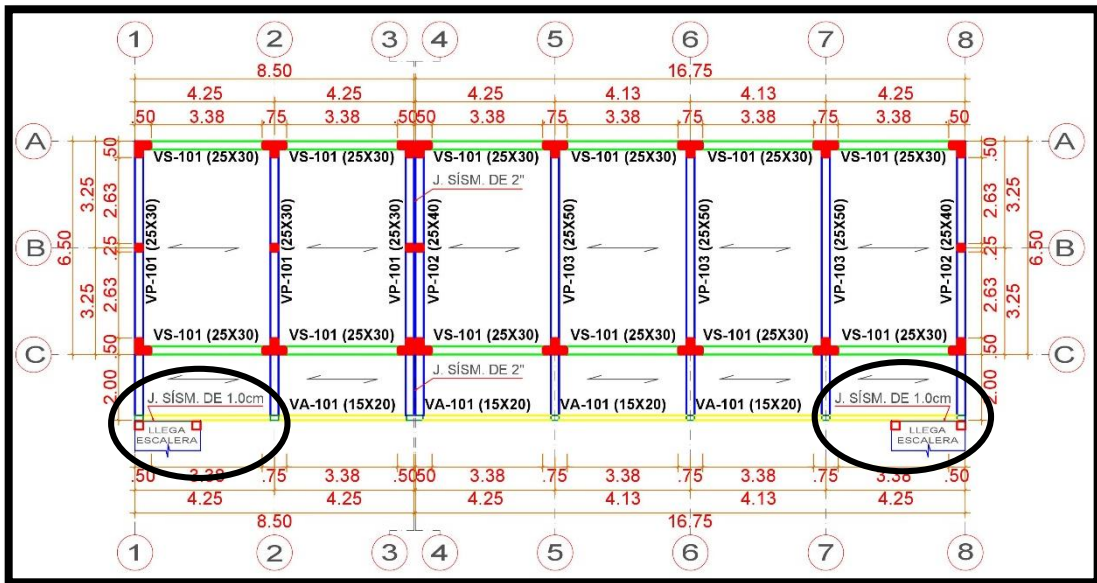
Plano de losa aligerada de 1° piso _Módulo IV y VIII; ubicación de las dos escaleras.
